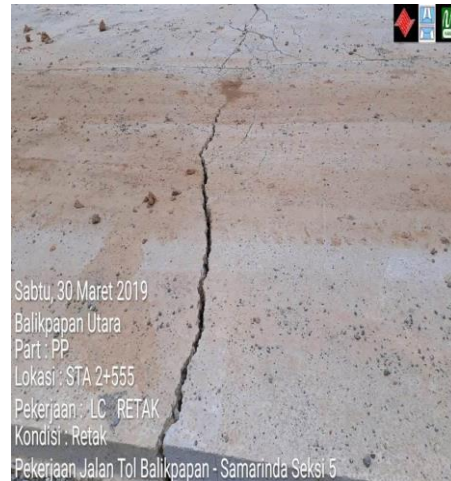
Retak di tepi (*corner breaks*) pada *rigid pavement* Sta.2+550
